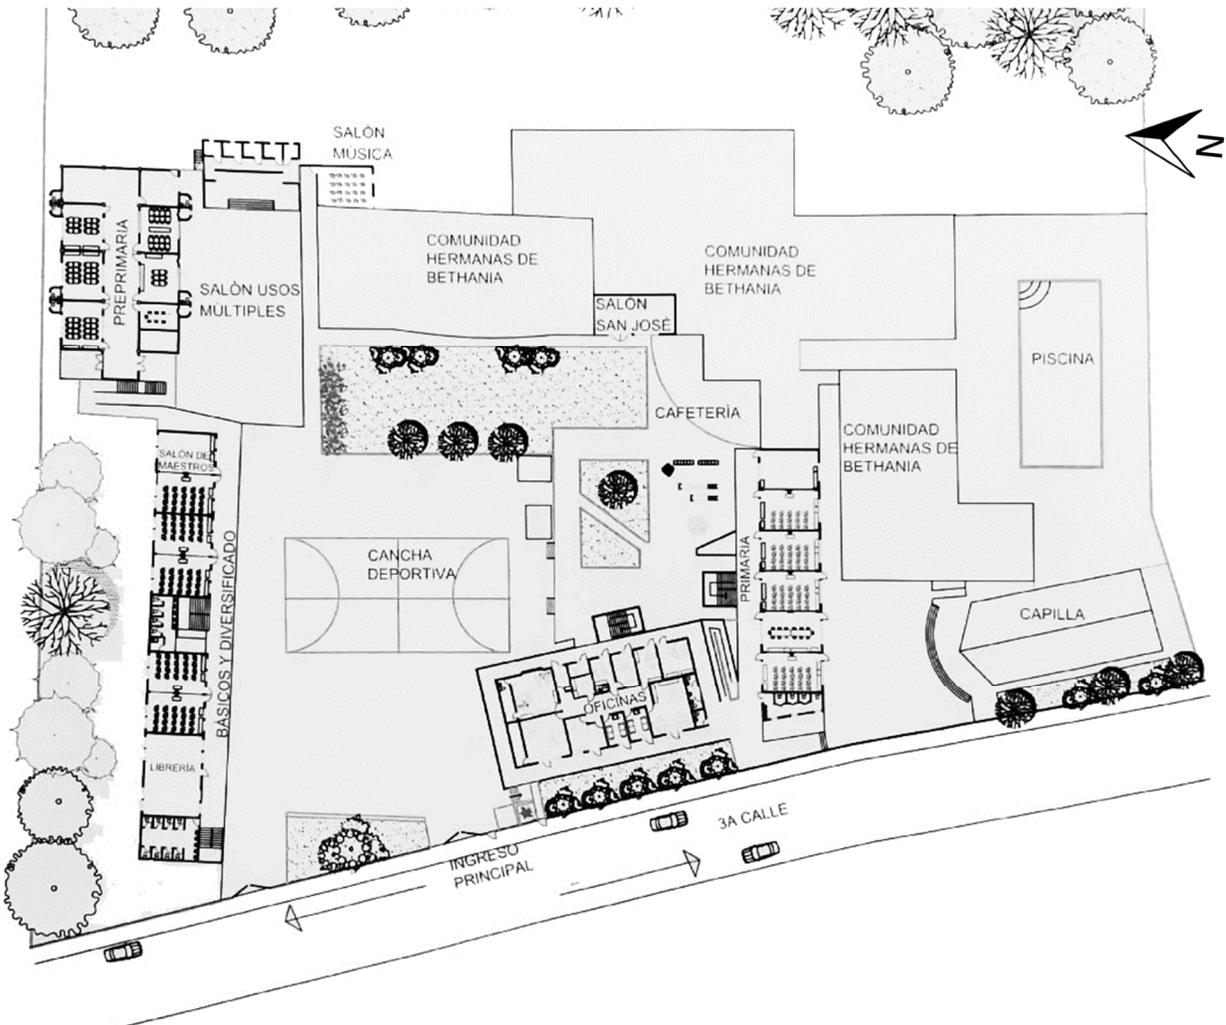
Planta de Conjunto. Fuente: Congregación de Hermanas de Bethania.
